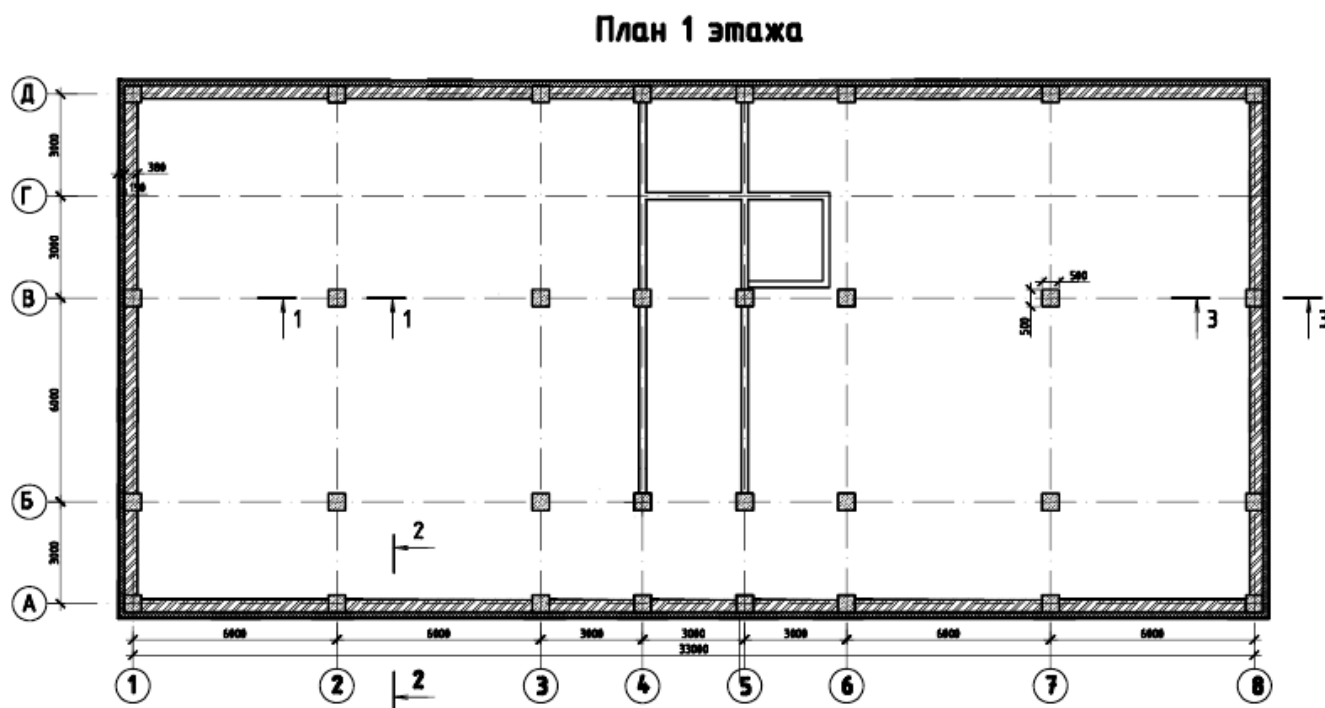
План здания на отметке -2,150
